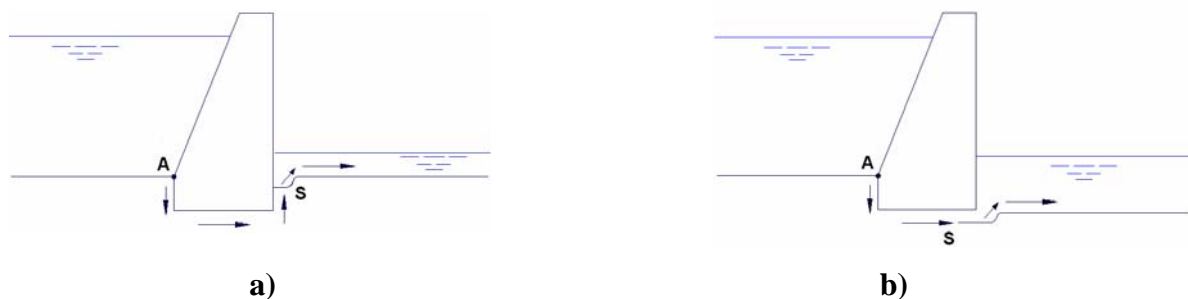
a) Inicio de la tubificación; b) Avance de la tubificación. Colapso inminente
